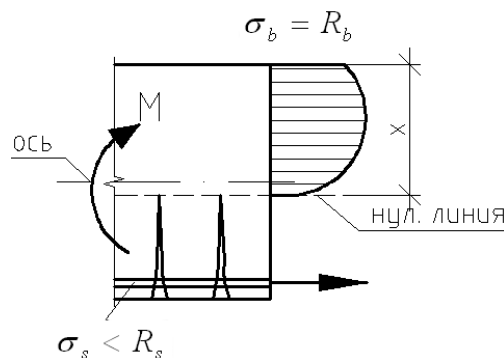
Схема образования пластического шарнира в железобетонных балках
